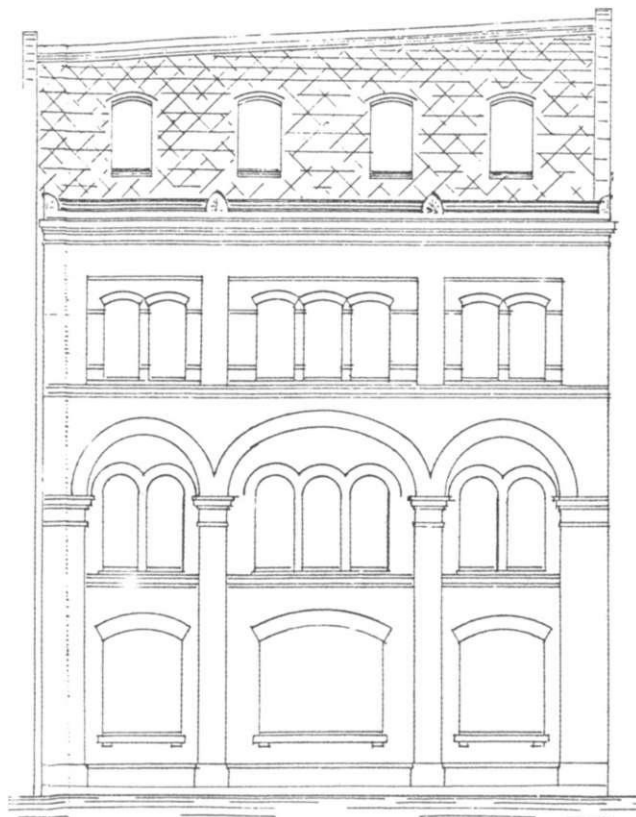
Karl-Schmidt-Straße 9, Fassadenaufriß 1894
